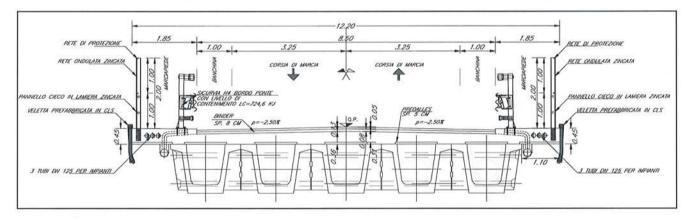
Sezione tipo cavalcaferrovia campata. L=25.00 m
